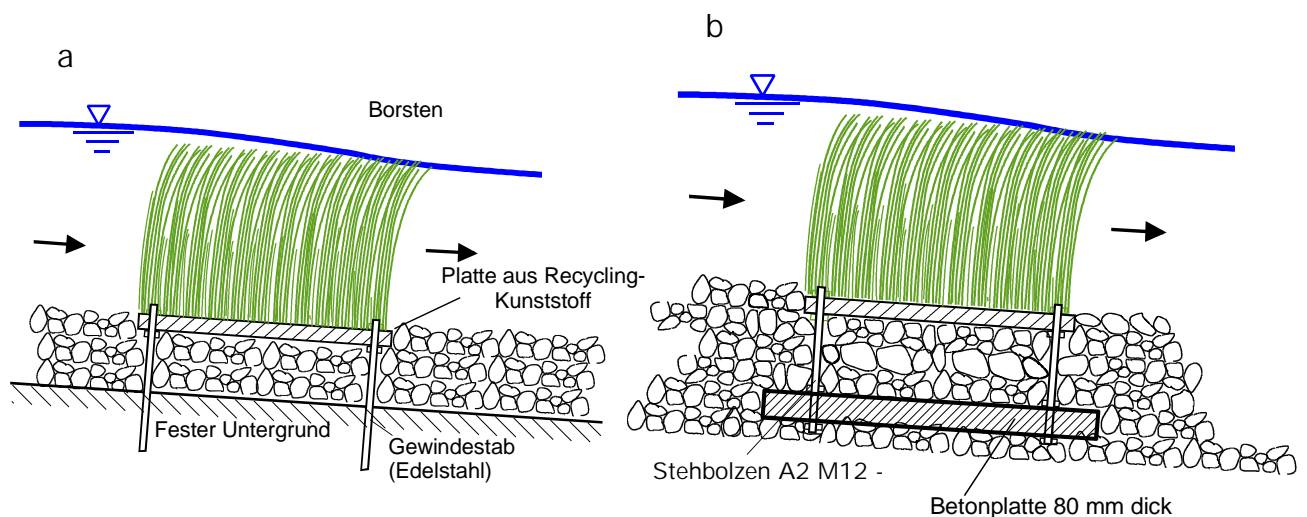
Befestigung der Borstenelemente (a – auf festem Untergrund; b – in Lockermaterial)
